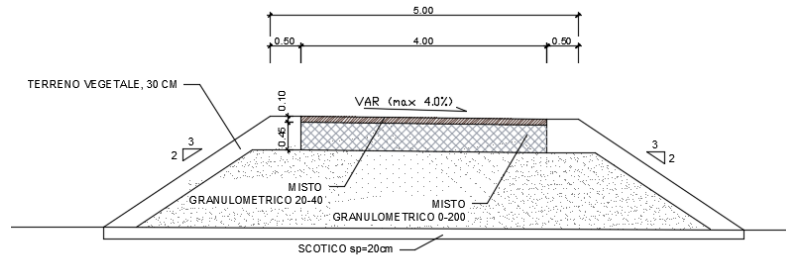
Sezione tipo in rilevato carreggiata 4 m.
